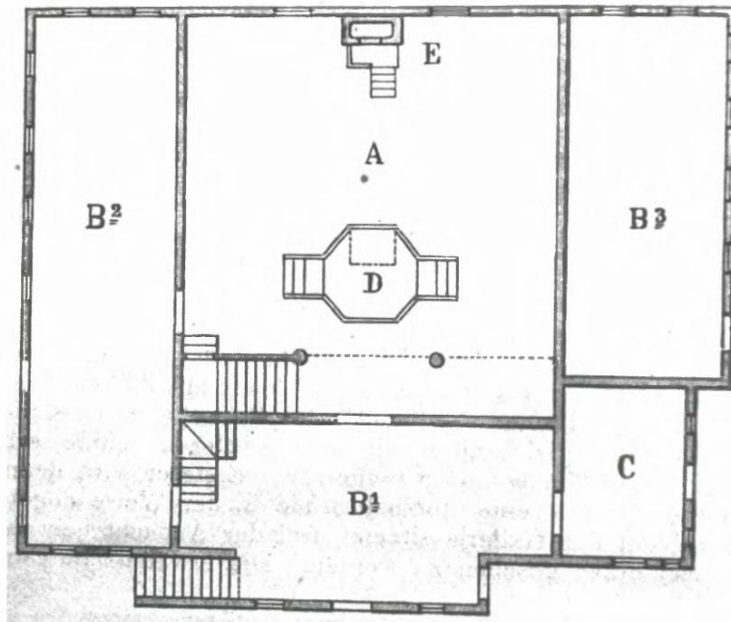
Synagoge in Zabłudowo, Grundriss, publiziert 1901
